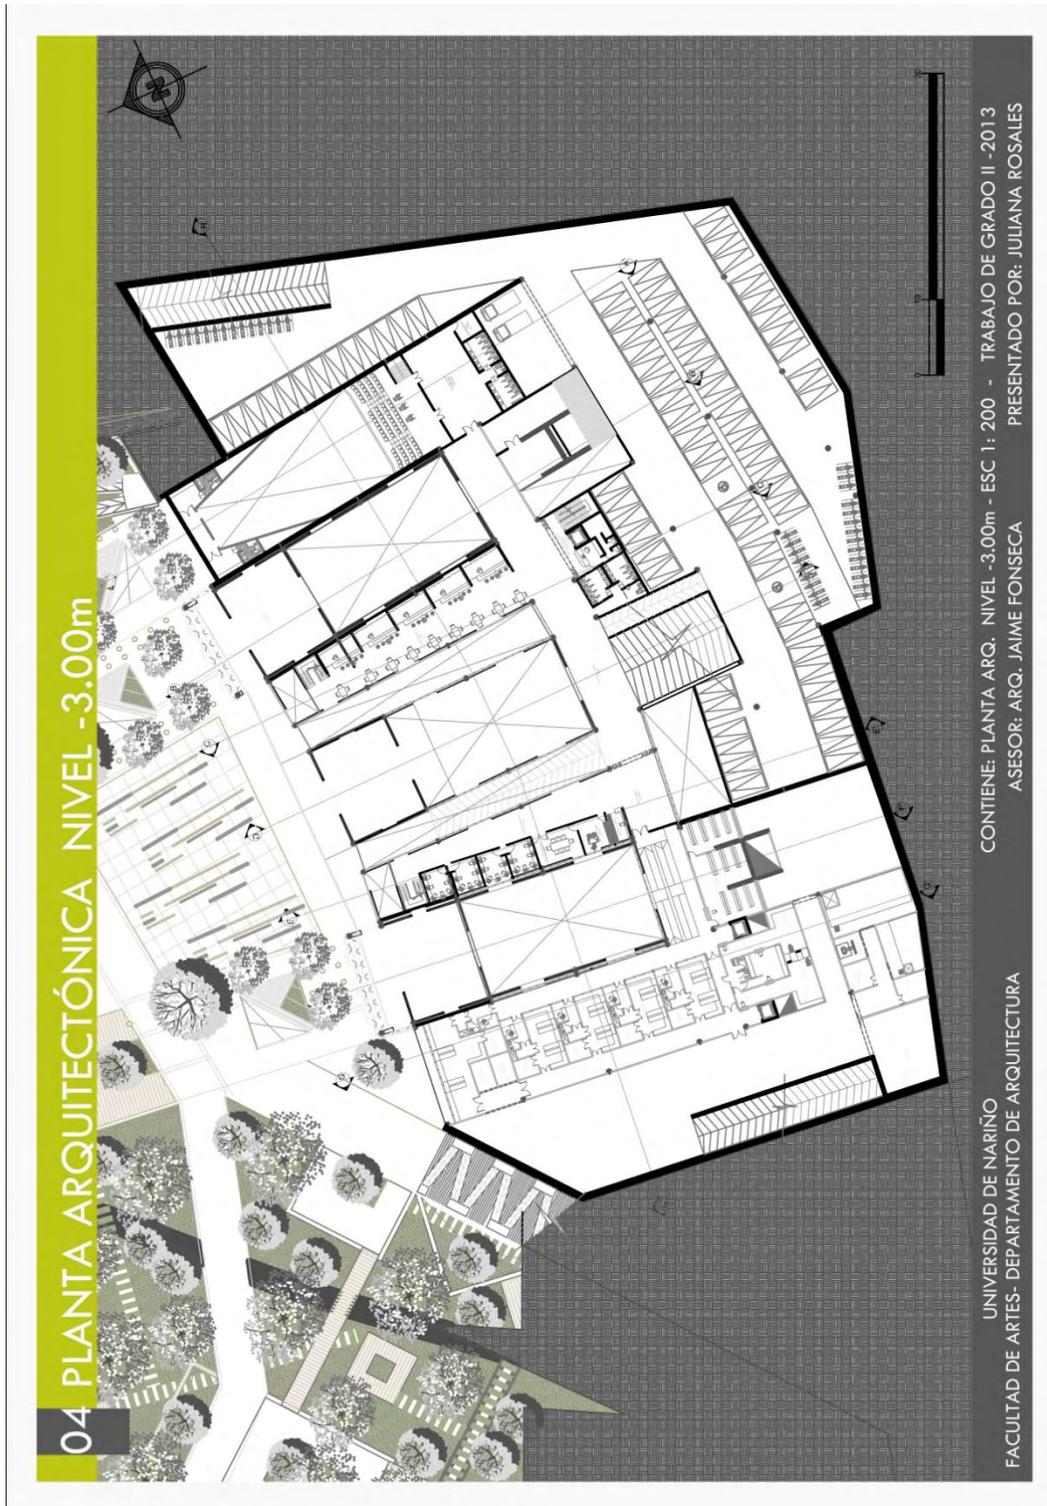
Proyecto_Planta nivel -3.00m // Fuente esta investigación
